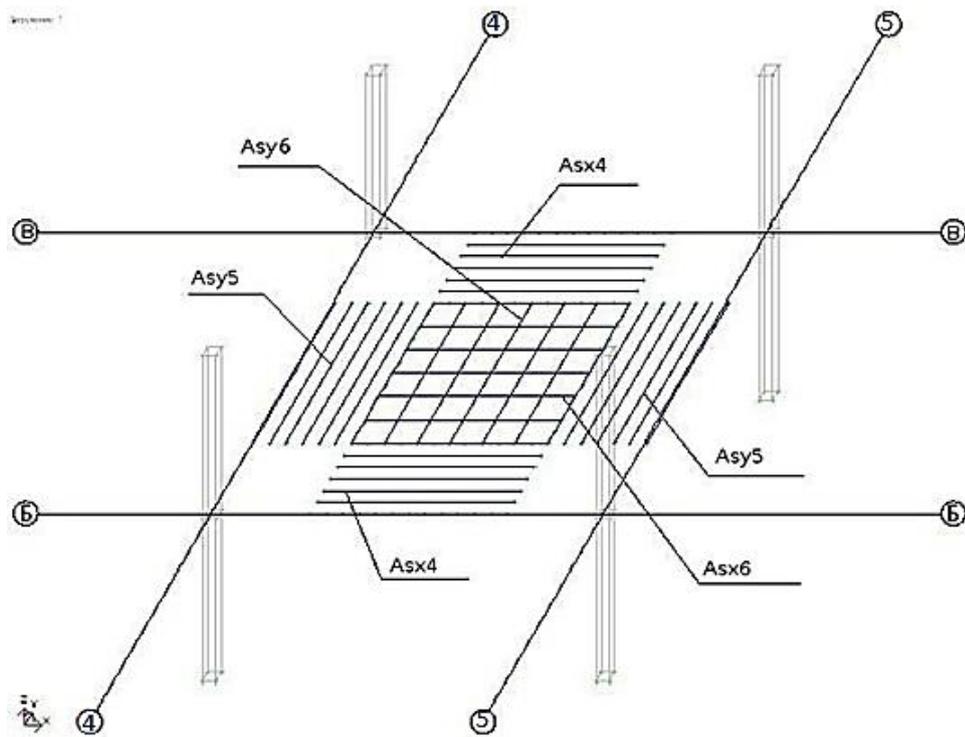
Схема нижнего армирования плиты перекрытия
